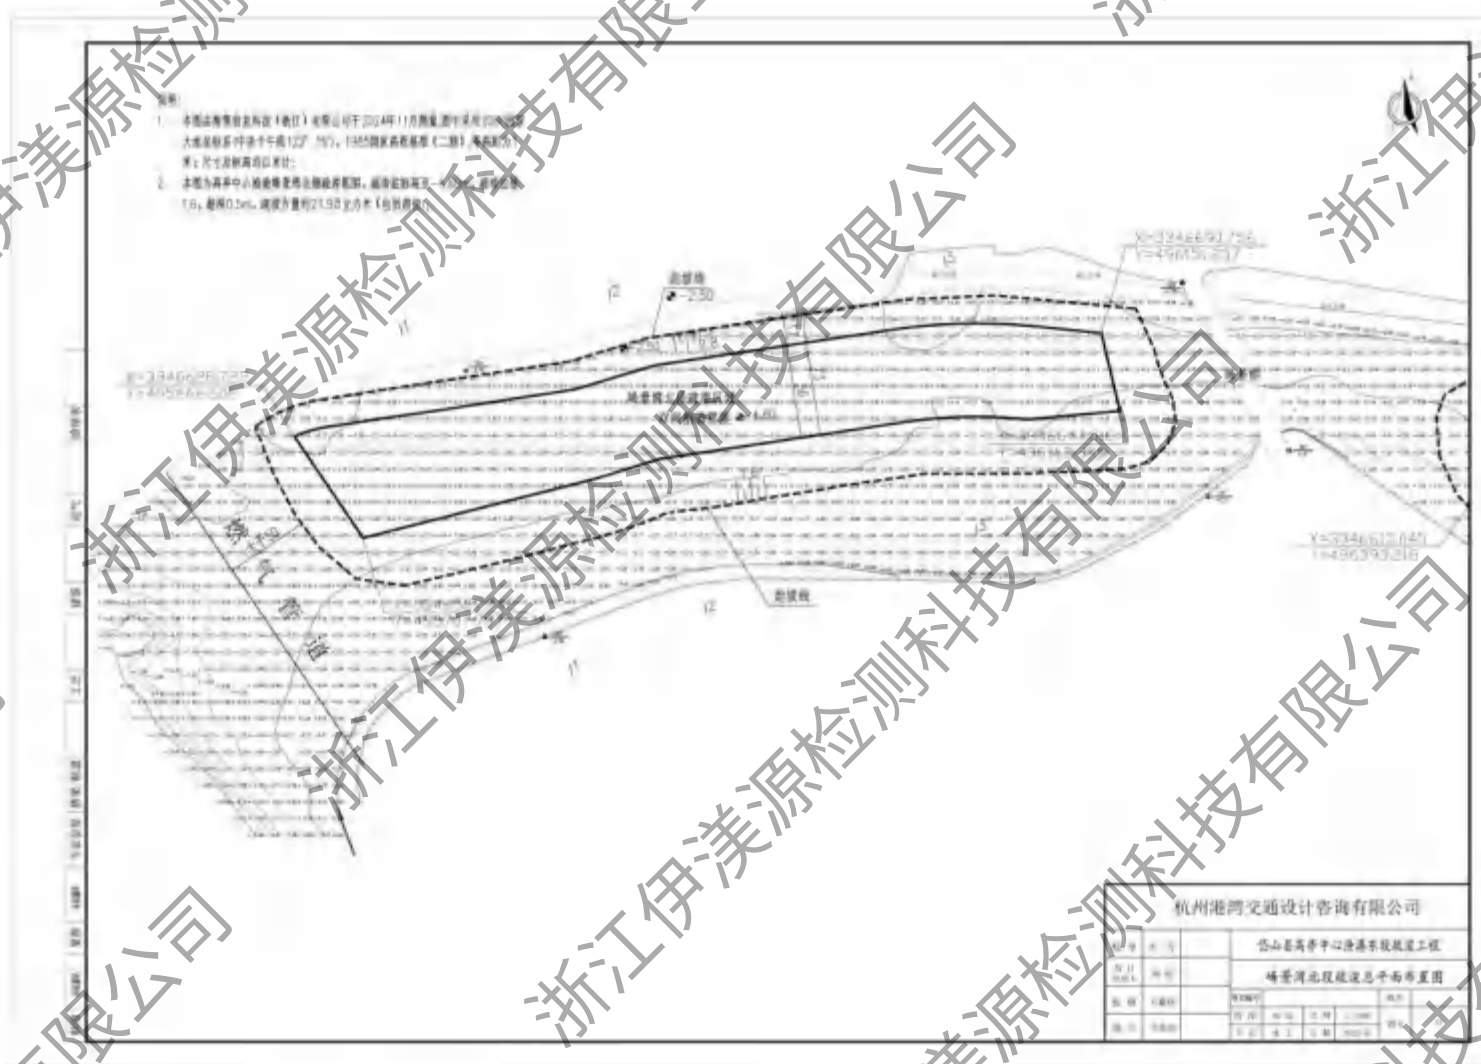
环评阶段总平面布置图（峰景湾北段）
